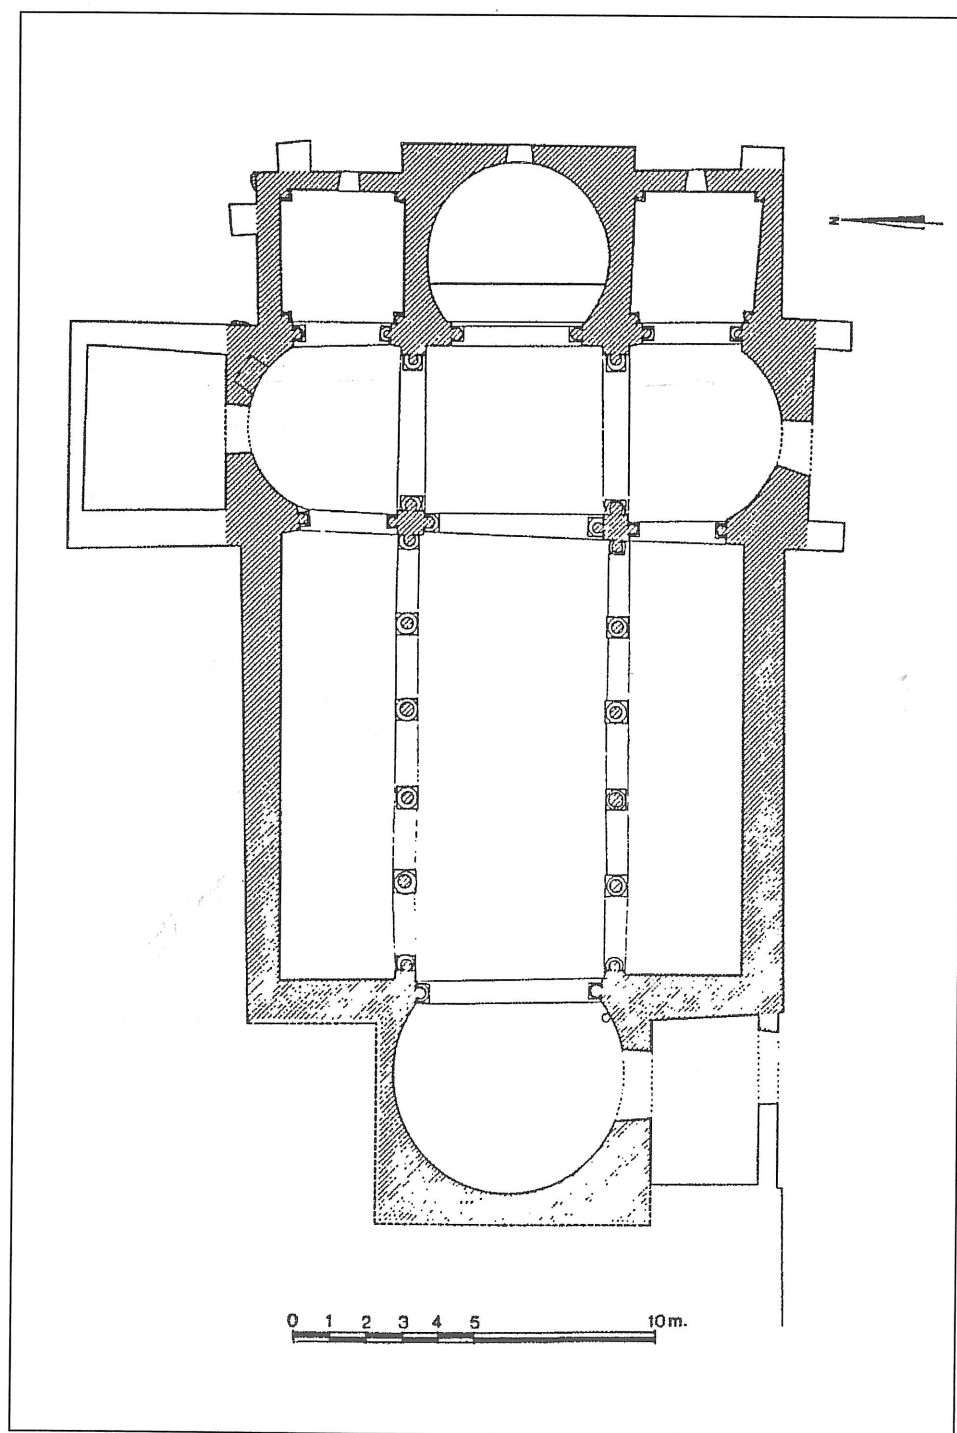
San Cebrían de Mazote (Valladolid). Planta (según: Gómez-Moreno)
